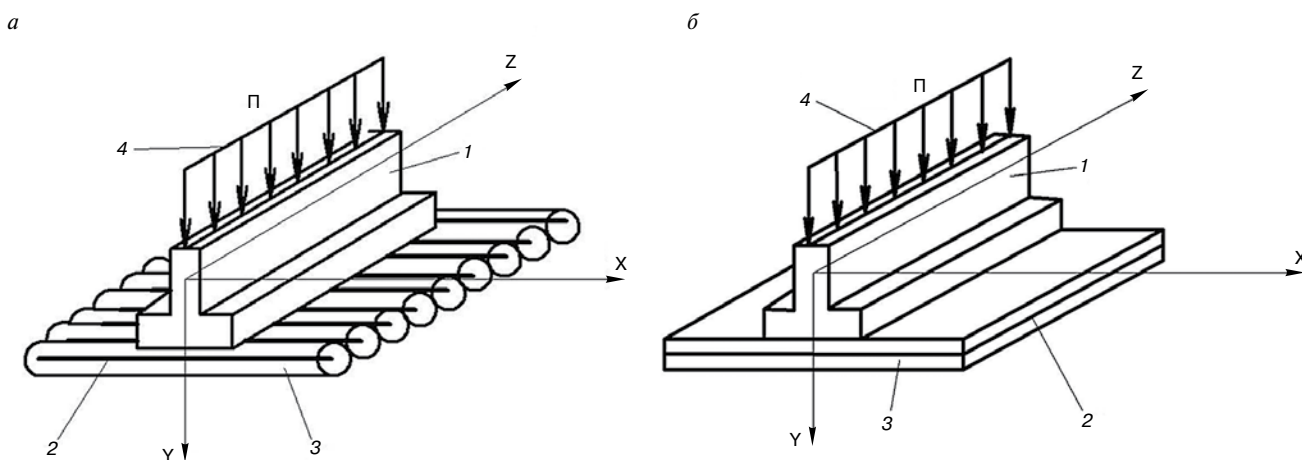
Схема усиления основания фундамента (а) и расчетная модель (б): 1 – ленточный фундамент; 2 – геоимплантат; 3 – зона уплотненного грунта; 4 – распределенная нагрузка
